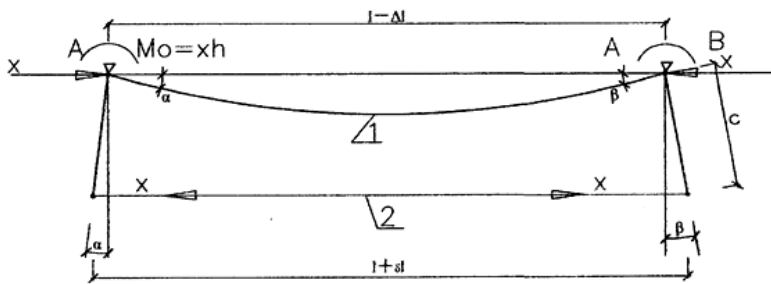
Расчетная схема и схема деформаций комбинированной системы образуемой горизонтальными затяжками а- расчетная схема; б – схема деформаций; 1- усиливаемый элемент; 2- затяжка
